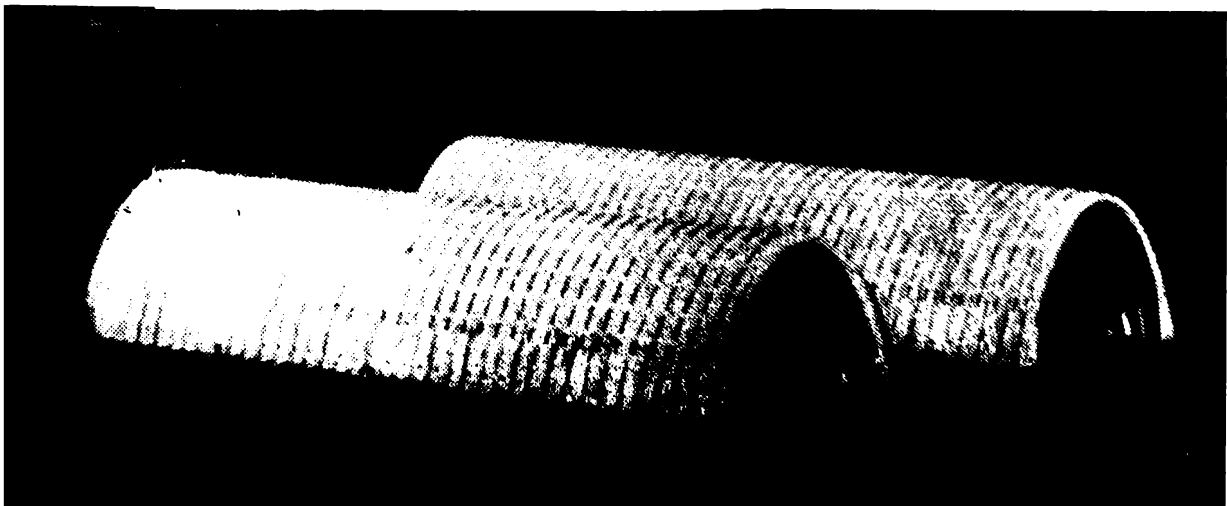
Hangar din beton armat construit in 1916 in Franta (Orly)
